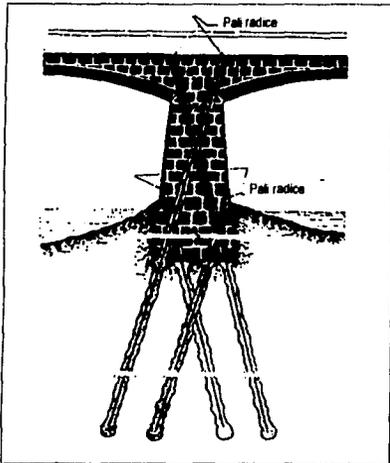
Recimentación del muro de un puente con Pali Radice (corte)
